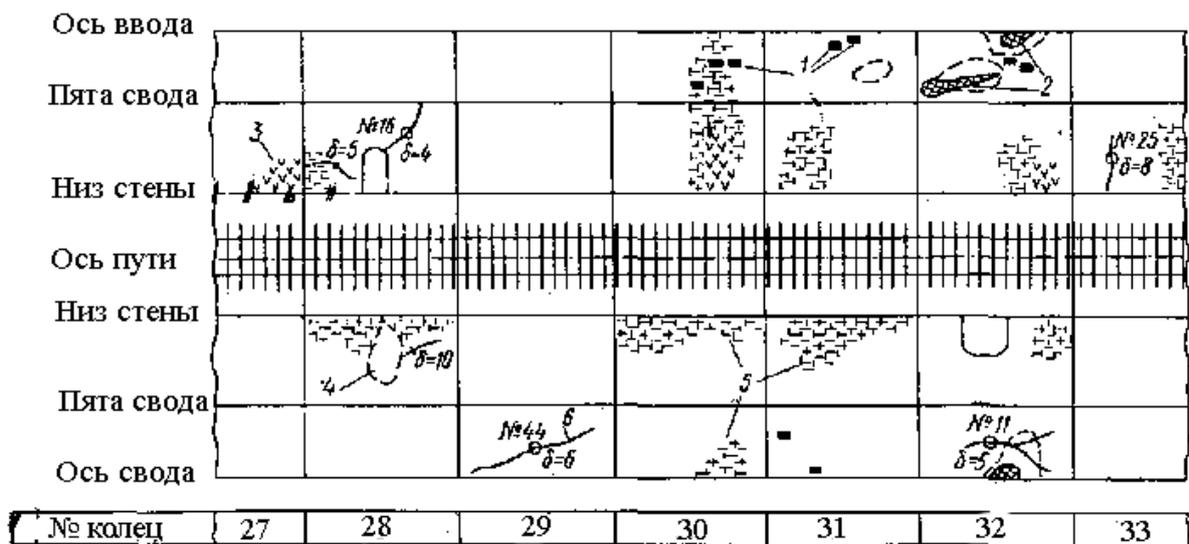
Развертка тоннельной обделки с нанесенными дефектами: 1 – выпадение отдельных камней; 2 – вывалы из кладки; 3 – поверхностное разрушение кладки; 4 – места бурения при отстукивании; 5 – пустоты в швах; 6 – трещины с показом размеров их раскрытия в мм и № установленных маяков
